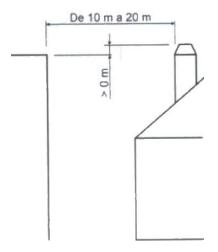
Distanza tra la finitura e oggetti tra 10 e 20 m
